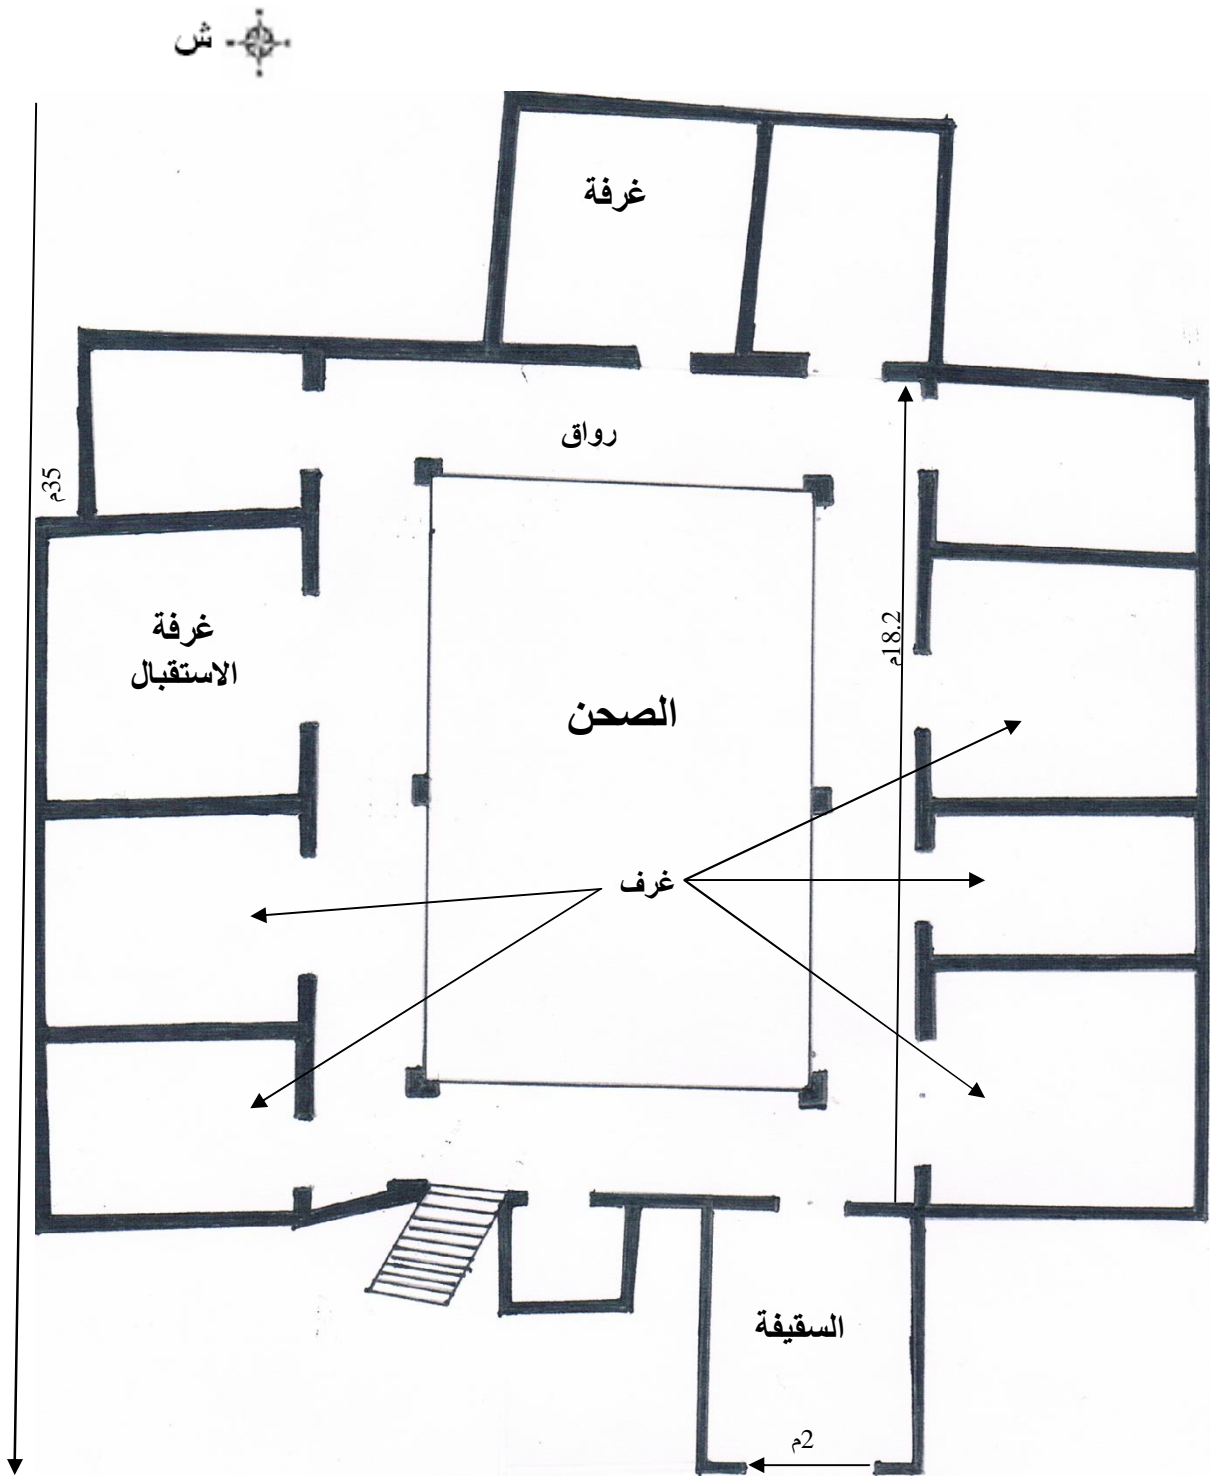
مخطط الطابق الأرضي لمسكن بن زيان
